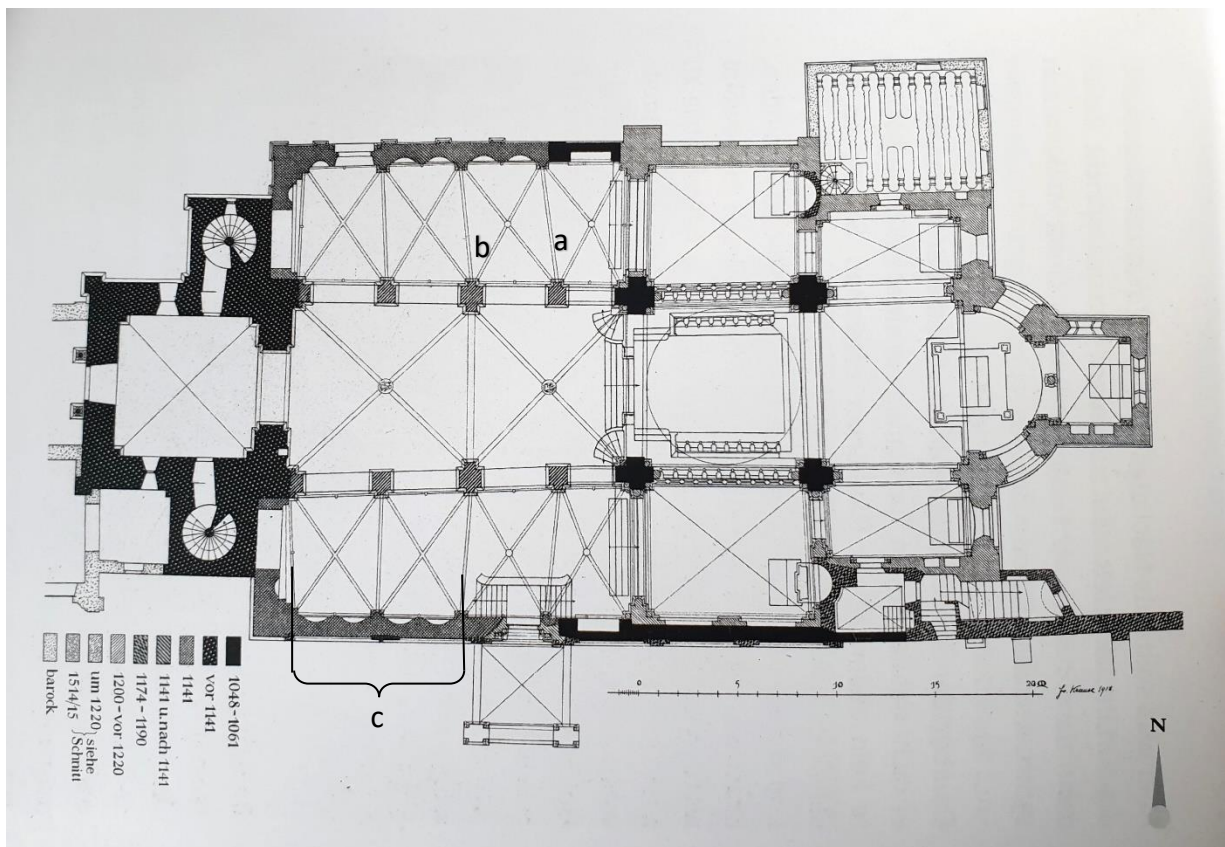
Grundriss der heutigen Abteikirche (ohne Vorhalle; Walter Bader, 1937)
